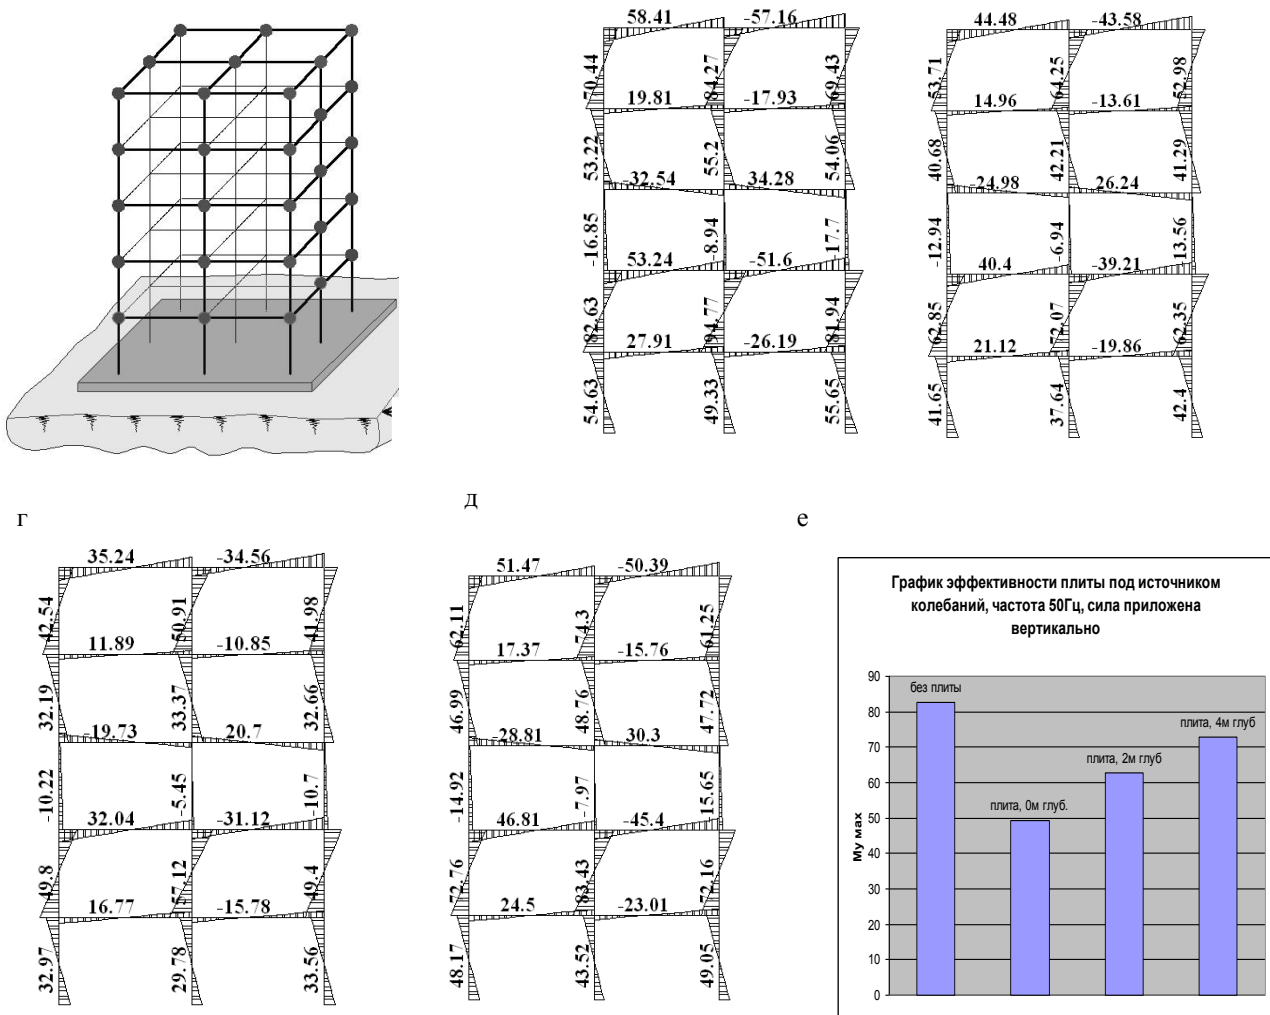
Пространственная расчетная схема 5-ти этажного каркасного здания на фундаментной плите, расположенной на грунтовом основании: а – общий вид; б-д - эпюры изгибающих моментов ($\text{kN}\cdot\text{m}$) в средней раме без жесткой подстилки, с подстилкой в виде бетонного блока под силой $P(t)$ на глубине $h = 2\text{м}$, $h = 0\text{м}$ и $h = 4\text{м}$, соответственно; е - изменение M_{max} в зависимости от глубины расположения жесткого включения (бетонного блока).
